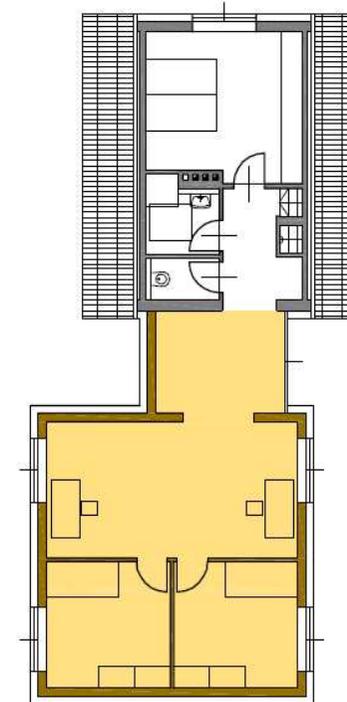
Variante III - Grundrisse⁸⁸
